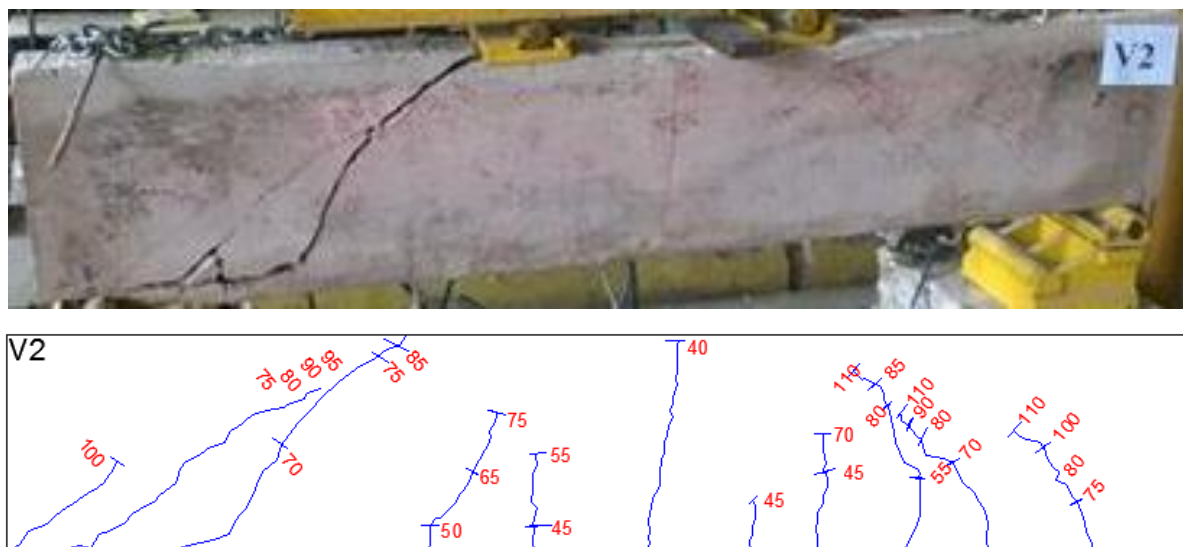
Viga V2 pós-ensaio / Mapa de Fissuração
